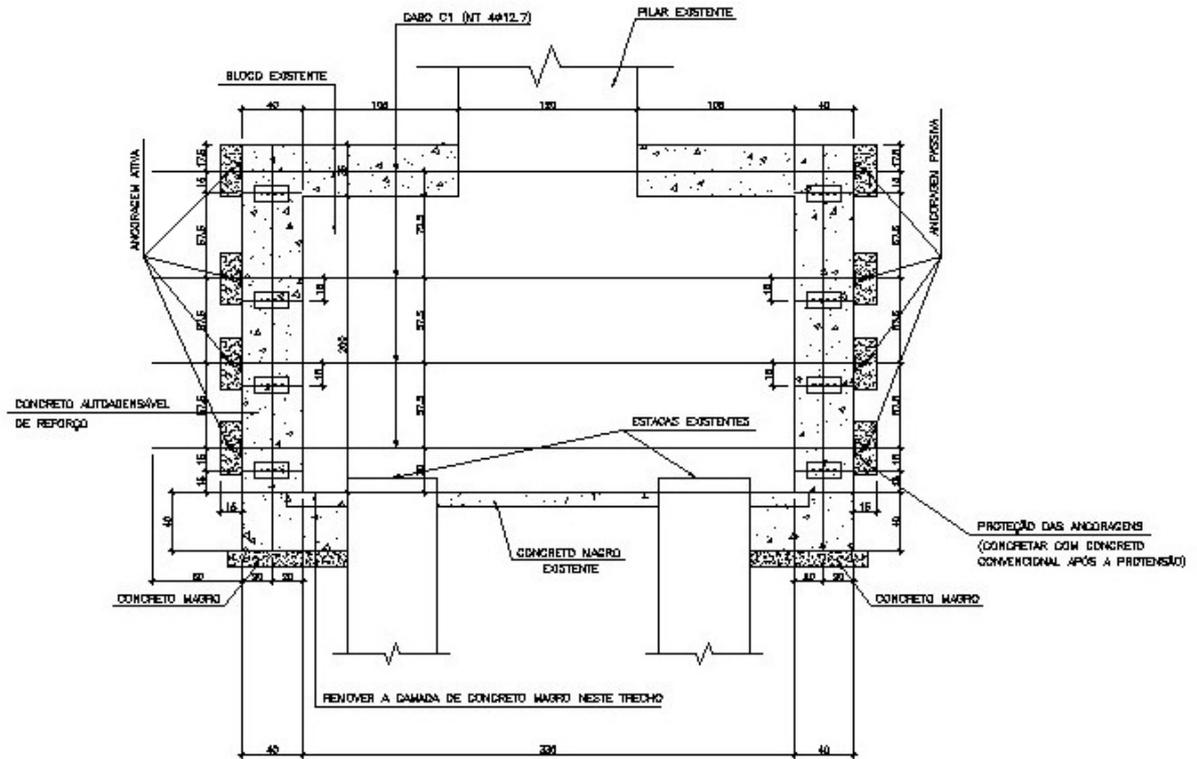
Detalhe do reforço do bloco com concreto auto adensável e protensão com cabos horizontais ao longo do perímetro. (Fonte: VITÓRIO, 2014)
